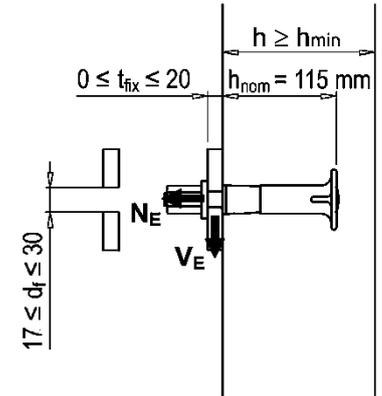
Einbauzustand Gesimsankerschraube Rd 16 mit montierter Stahlplatte
